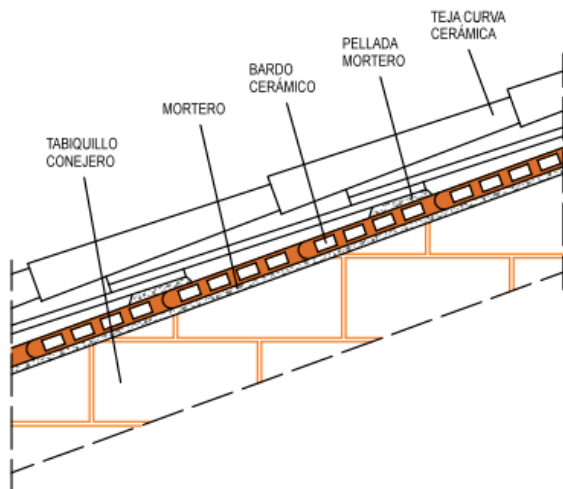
Sección cubierta principal existente en vivienda. Fuente propia.
